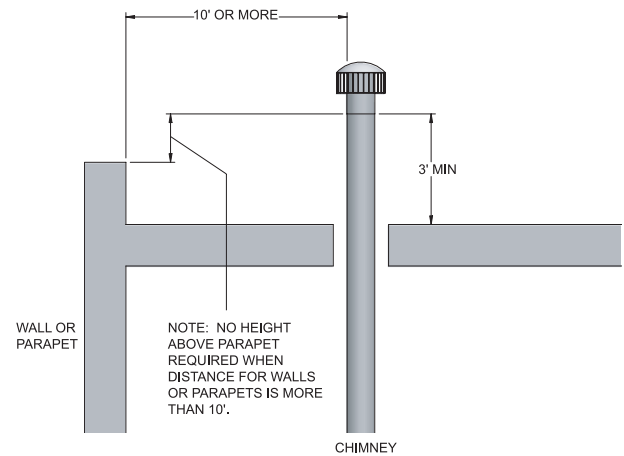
Terminaison de ventilation depuis un toit en terrasse - à 10 pi. au minimum du parapet
